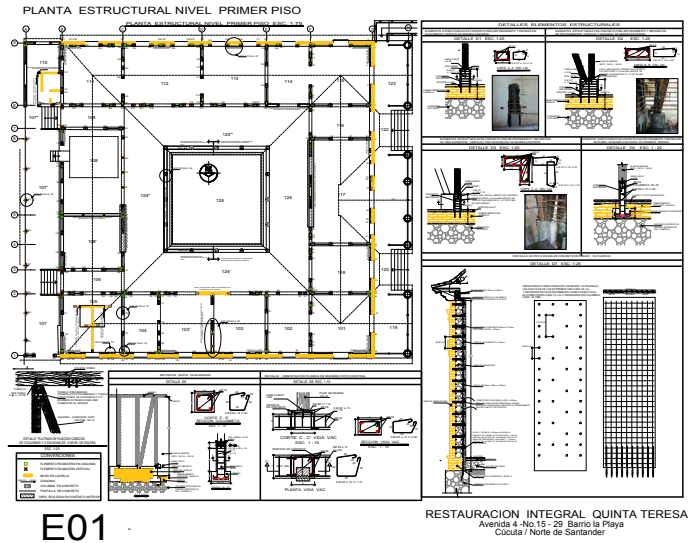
Plano record de las obras- Planta primer nivel- proyecto de Reforzamiento Estructural. Fuente: Obra de restauración integral a cargo de Segundisalvo Pardo Barreto.
